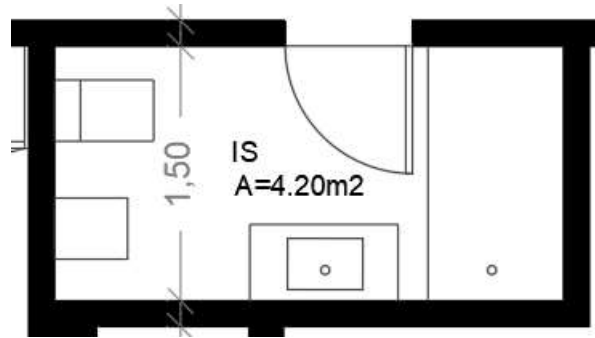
Planta com indicação de vista da casa de banho da suite (Projeto AP). Fonte: Autora
